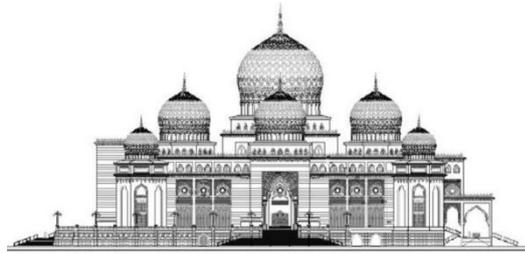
Denah Bangunan *Islamic Center* Lhokseumawe
